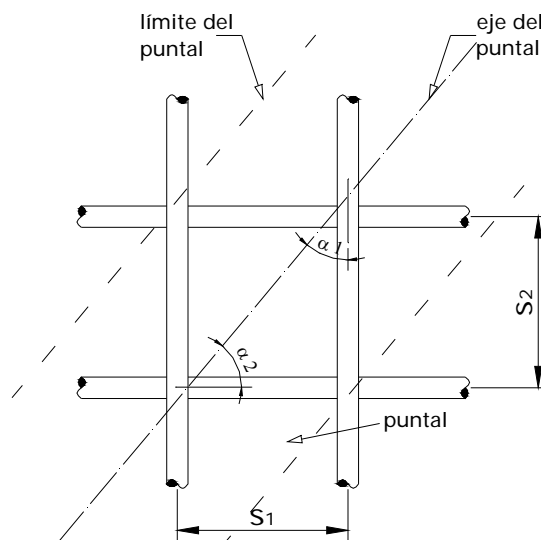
Refuerzo que atraviesa un puntal (adaptada de ACI 318-11)
